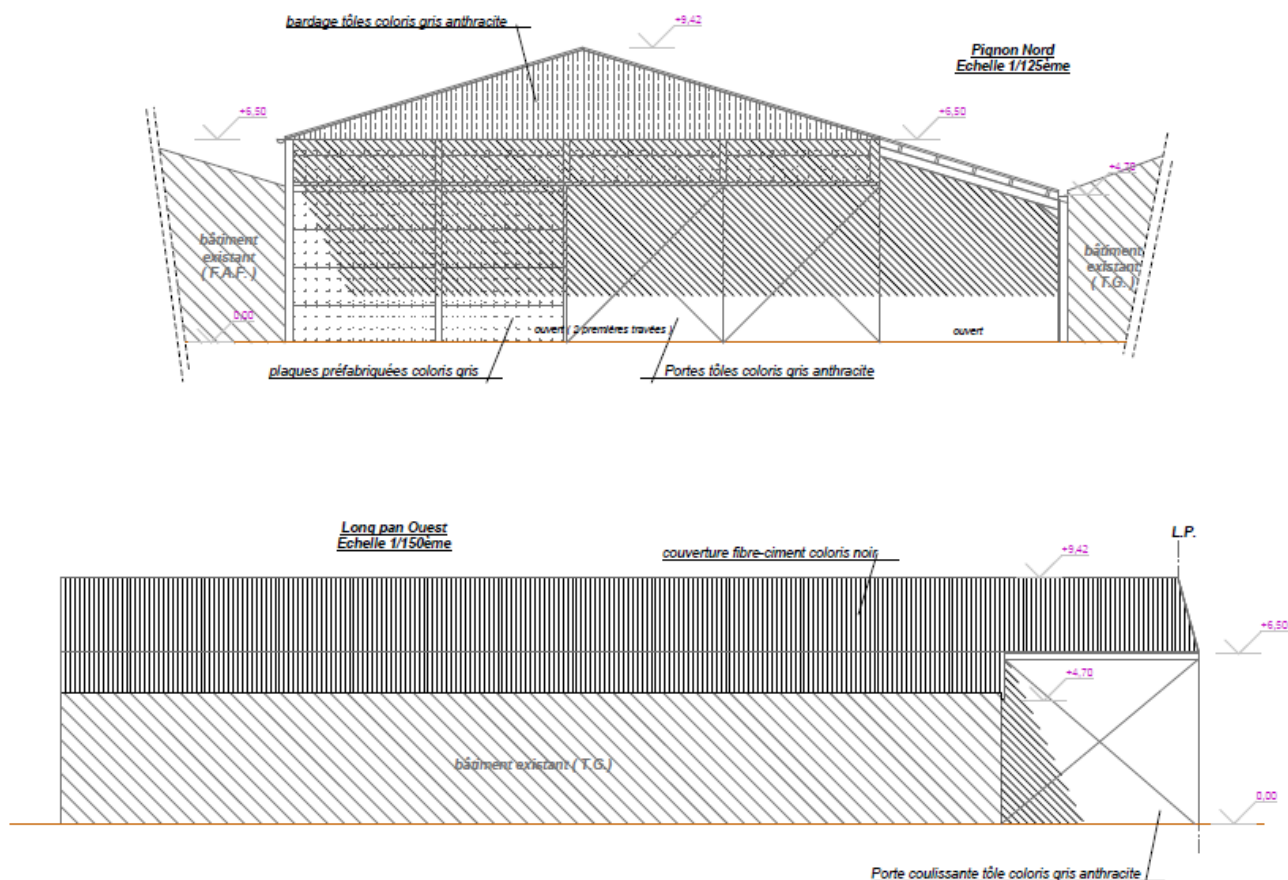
projet hangar, Pignon Nord et Long pan Ouest (extrait du permis de construire)
